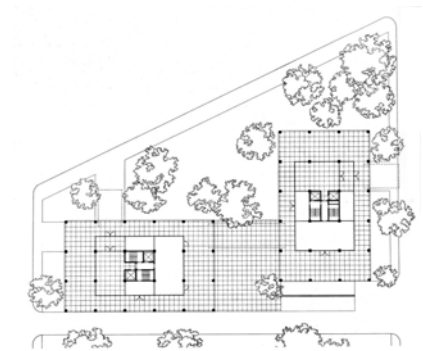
MIES, planta baja de 860-880 Lake Shore Drive.
